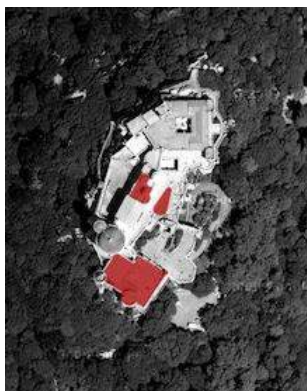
Planta de localização e zonas de intervenção (Vermelho)
